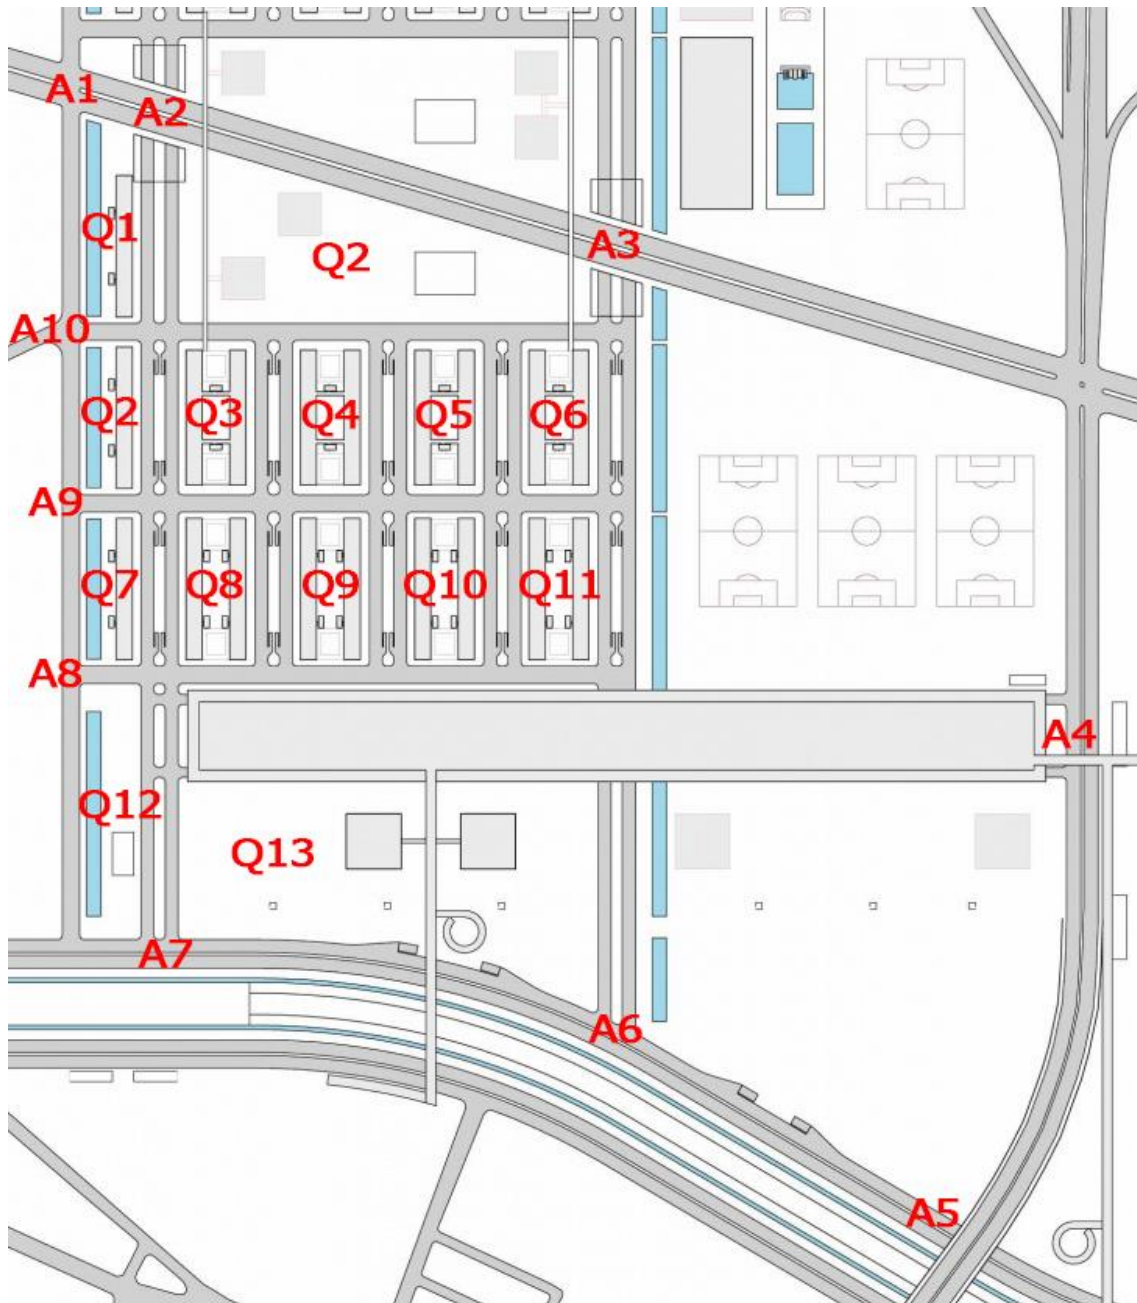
Implantação da Vila Olímpica na gleba da TELESP, com a indicação dos acessos (A1-A10) e quadras com uso residencial (Q1-12). Fonte: Site do escritório MMBB: <https://www.mmbb.com.br/projects/details/57/2> - adaptada pelo autor.
